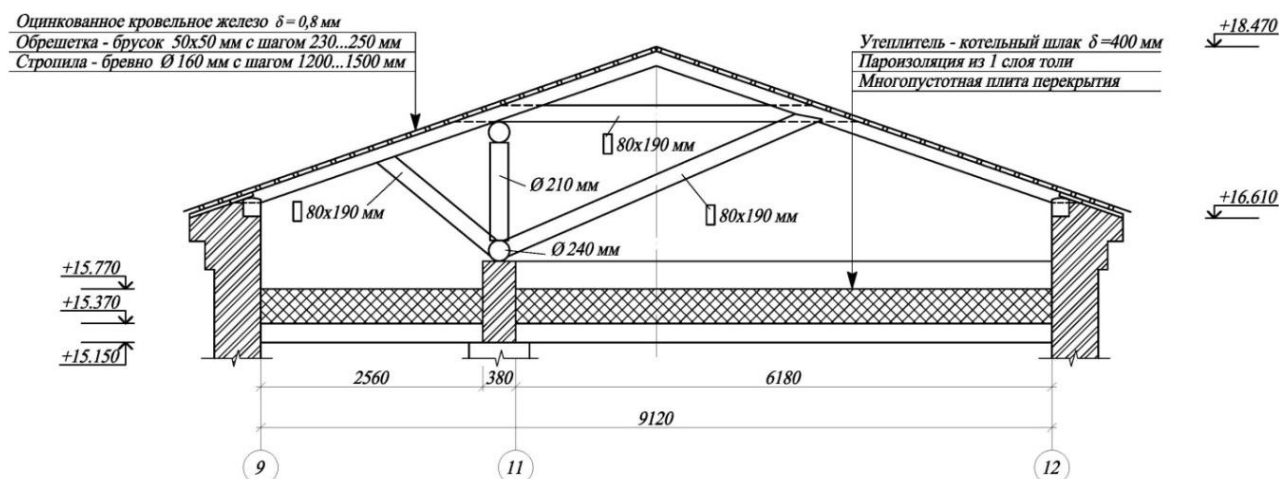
Поперечный разрез покрытия корпуса №1
